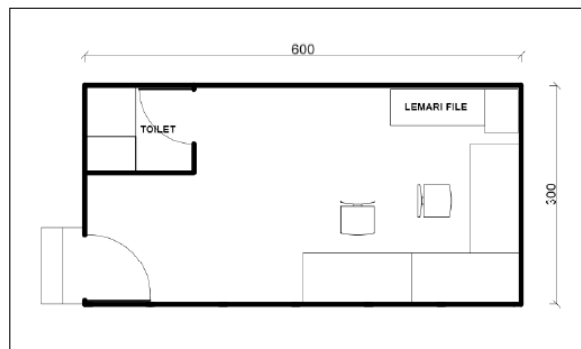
14 Tipikal Denah Ruang Kepala Stasiun
